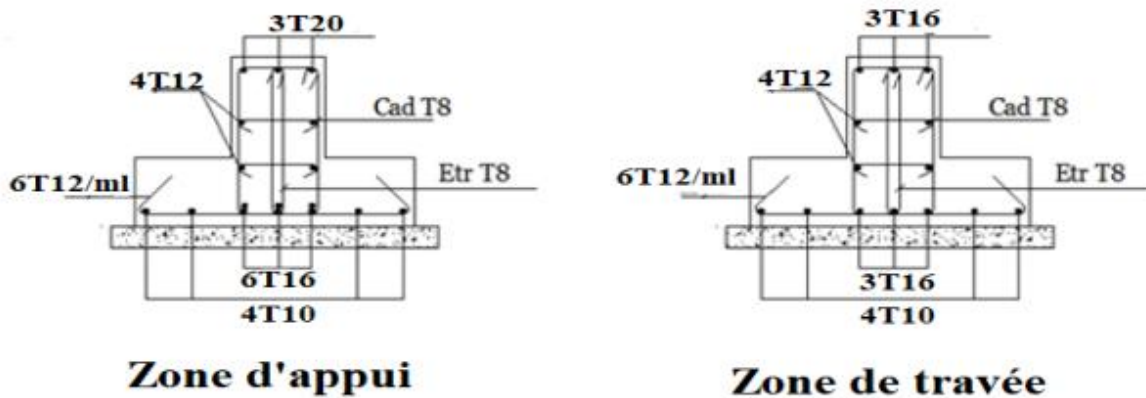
Schéma de ferrailage de poutre de rigidité
